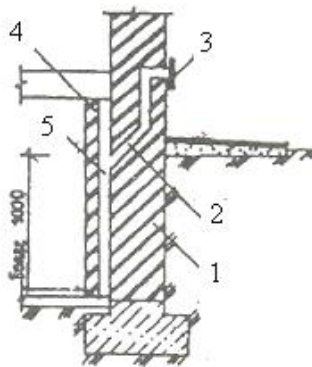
Устройство осушающей вентиляции стен подвала:
